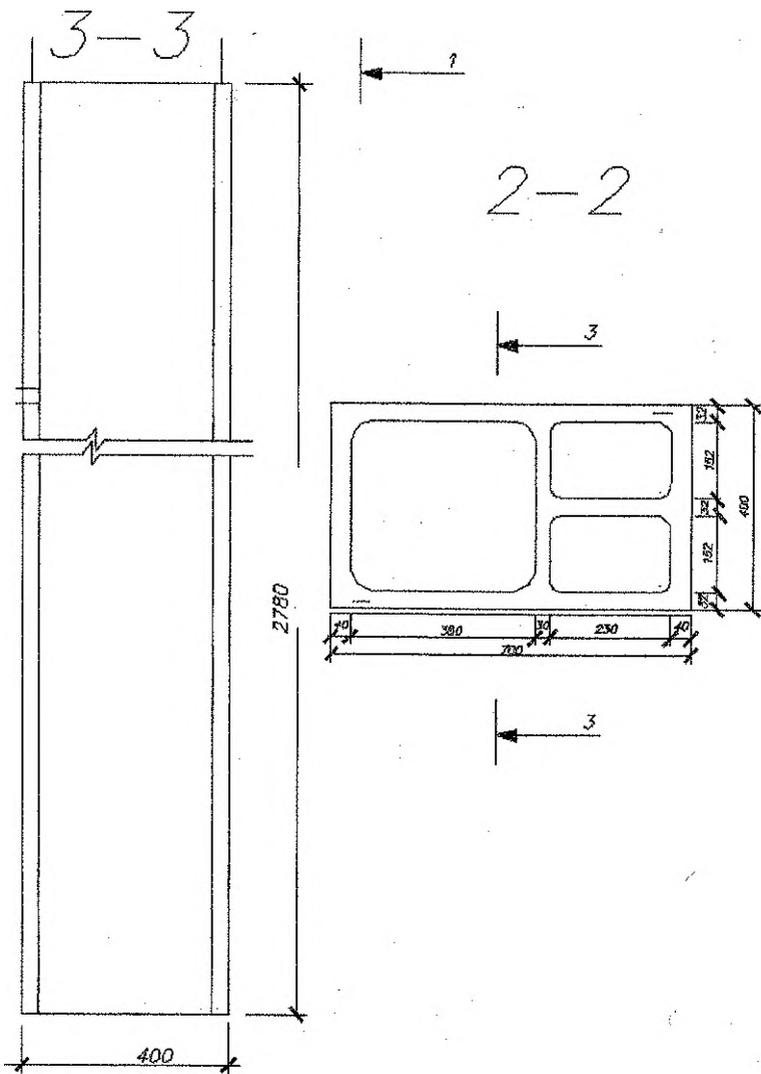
Размеры унифицированных железобетонных вентиляционных блоков серии Б1.134.1
